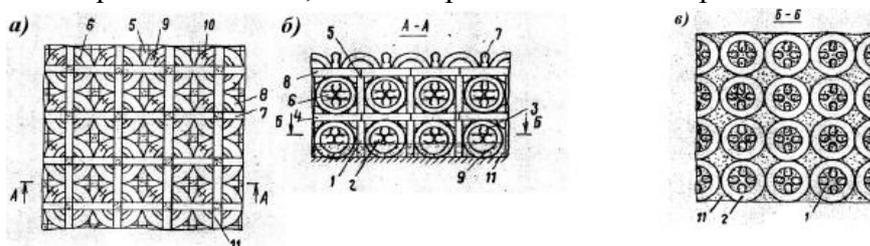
Покрытие поверхности земляных и бетонных сооружений (а.с. СССР № 1691453): а) вид в плане; б) продольное сечение А-А; в) поперечное сечение Б-Б.
